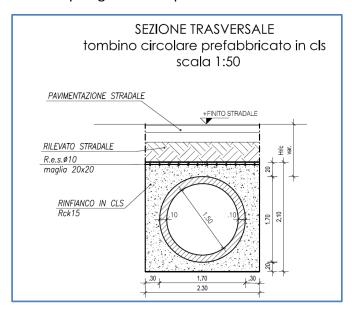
Sezione tipo dell'intervento di rinforzo della tubazione di diametro 1500 mm.
